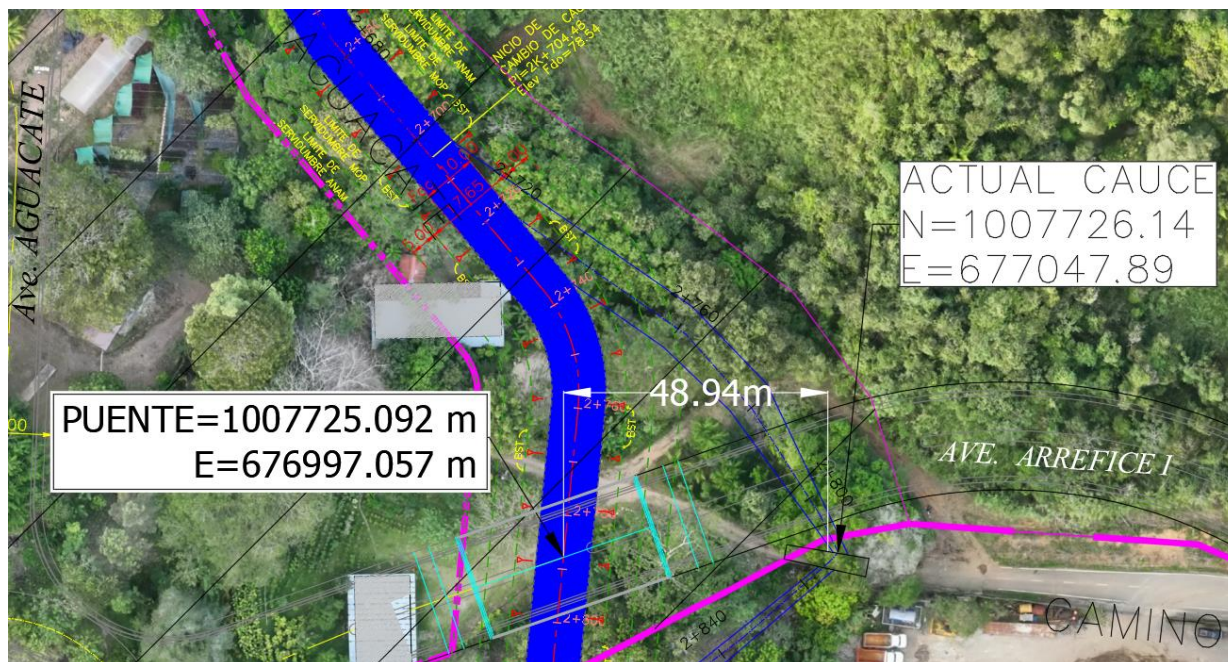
Puente y enderezamiento de quebrada AGUACATE
